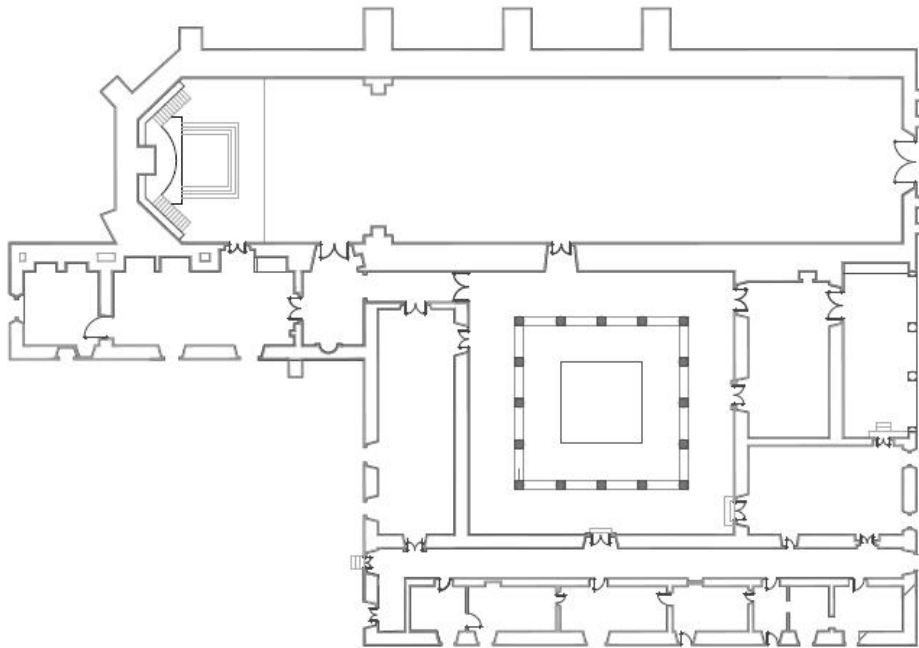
Planta arquitectónica, etapa constructiva 1610-1629⁵⁶
